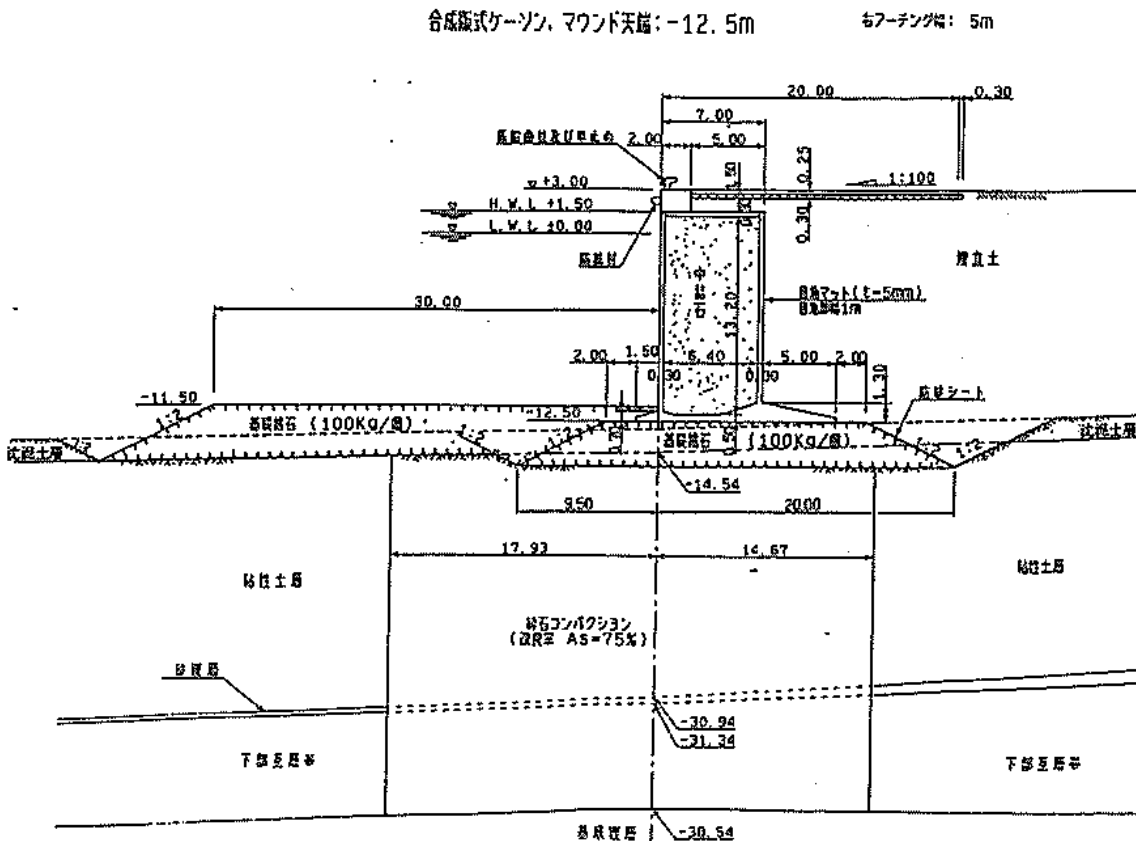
須賀地区岸壁 (-11m) の標準断面図
